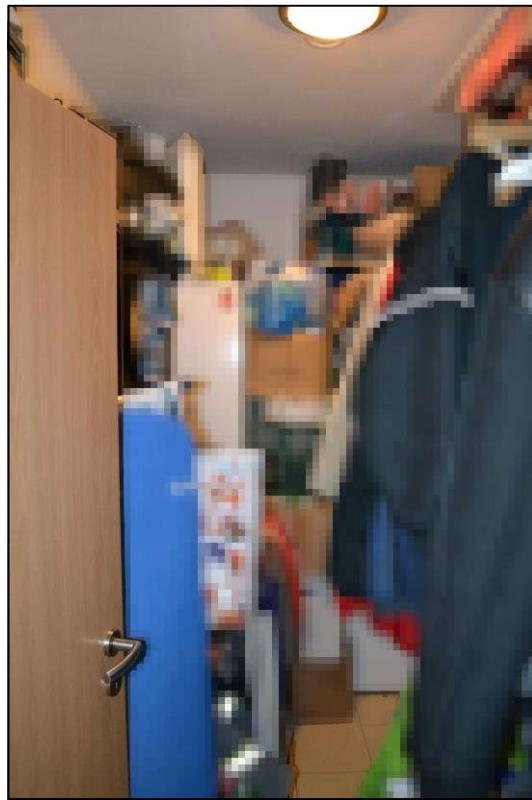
HWR mit Heizungs- und Lüftungsanlage (# 2)
